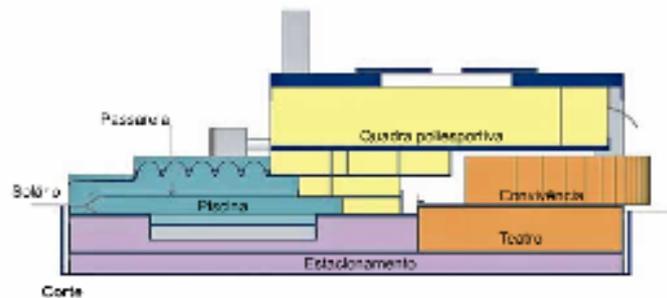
Corte do Sesc Santana São Paulo (PAIVA, 2008).
